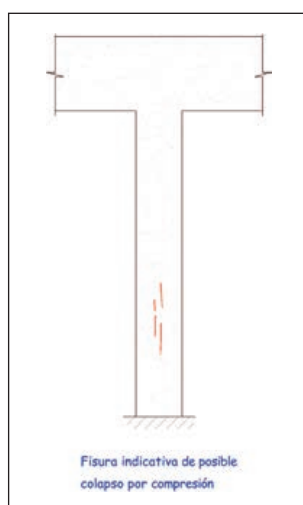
FISURACIÓN POR COMPRESIÓN.
